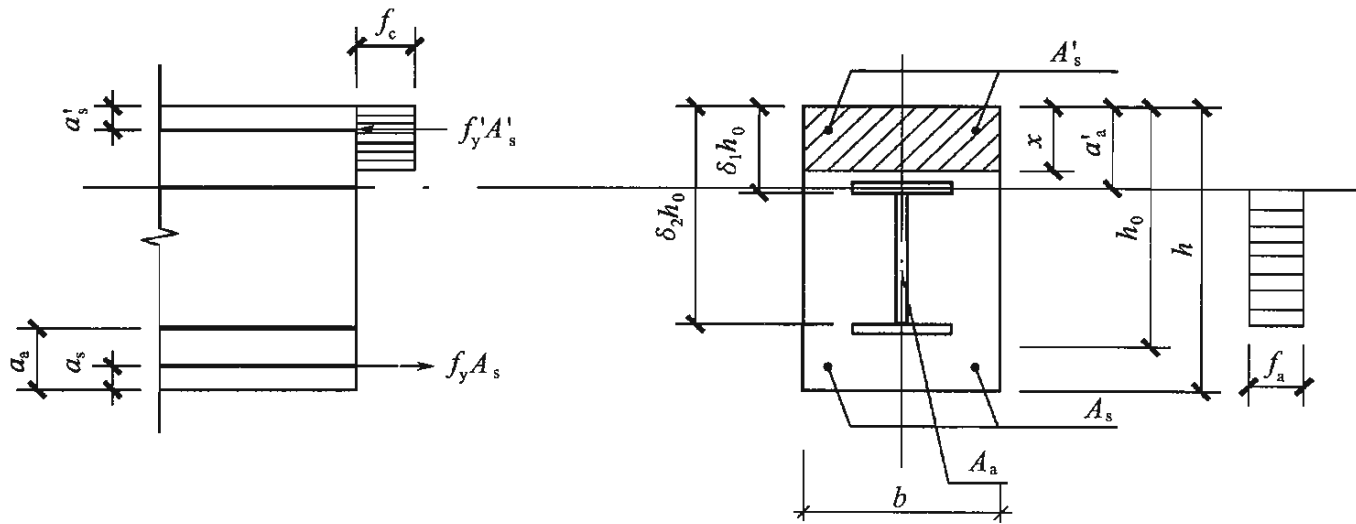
中和轴经过型钢翼缘满型实腹型钢混凝土梁受弯承载力计算简图
